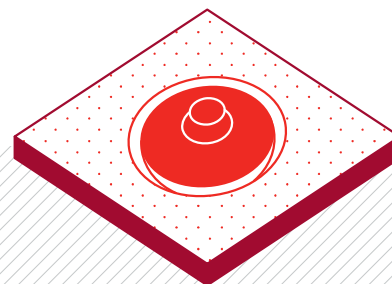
Schéma d'une fondation d'éolienne (source : EDPR)
